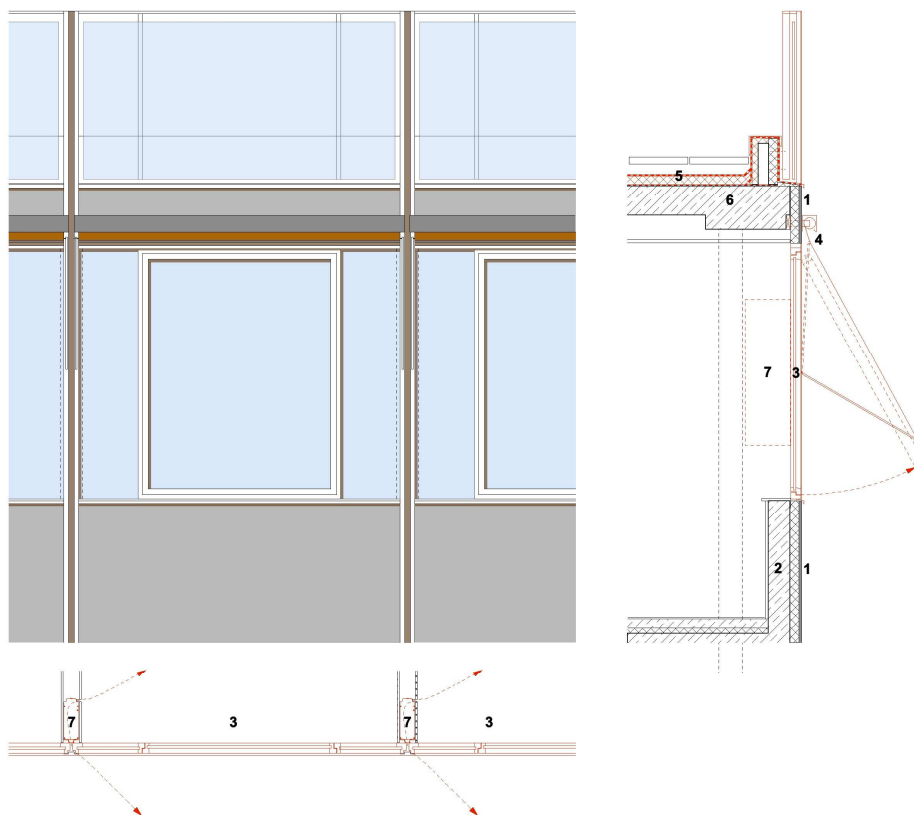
Skizze der Sanierungsmaßnahmen am Anbauteil des Hauptbaus (Südwestfassade mit Markise). Bestehende Bauteile in schwarz, neue in rot: 1 Wärmedämmverbundsystem mit Glattputz, 2 Stahlbetonbrüstung, 3 Klappschwingfenster, 4 Aufputz montierte Fallarmarkise, 5 Dachterrasse, 6 Geschossdecke, 7 Einzellüfter in Trennwand.
